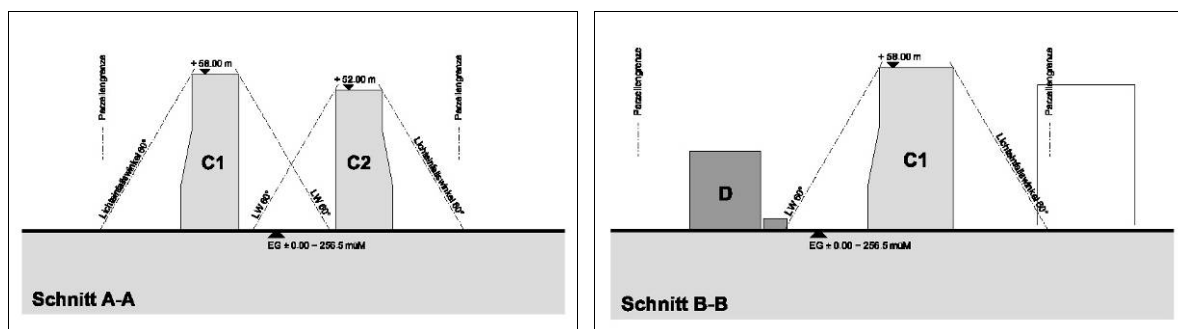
& 9: Bebauungsplan Areal Schoren, Schnitte. (ohne Massstab, Plan genordet)
